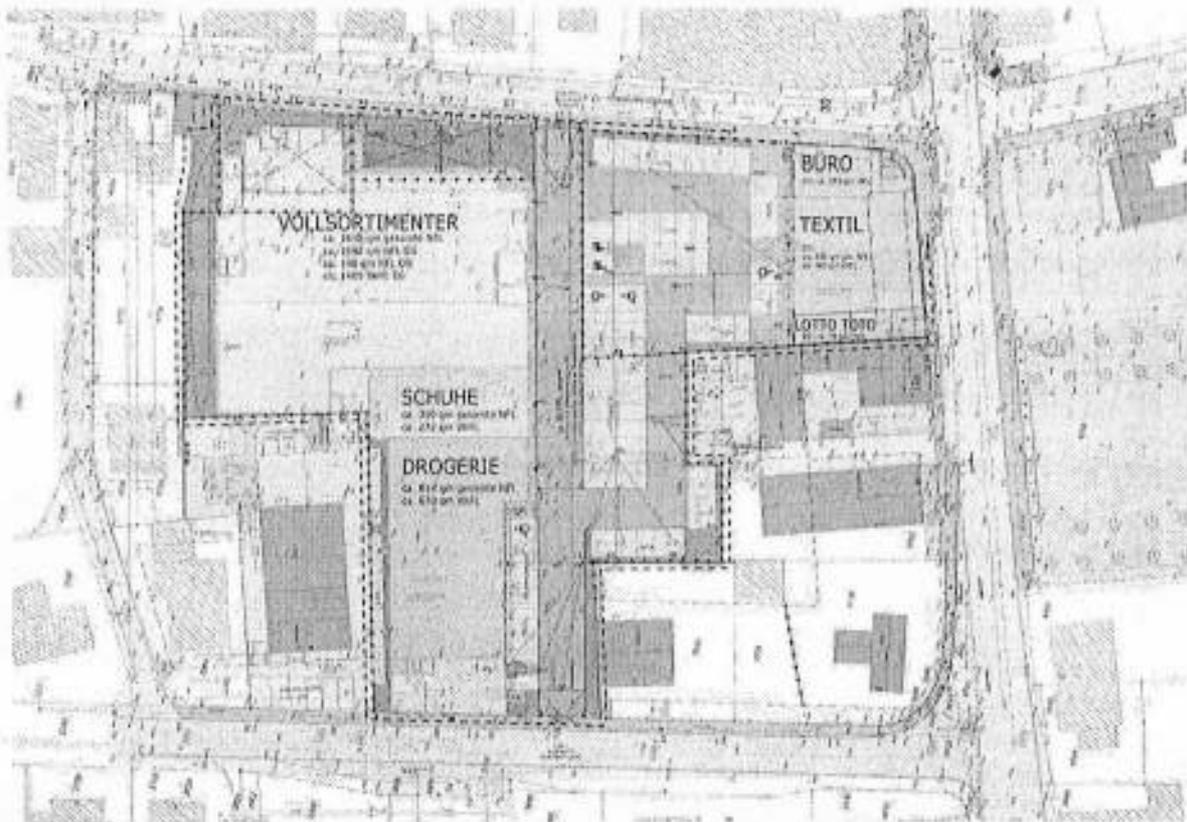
Lageplan (Quelle: Lageplan Variante 34, Ten Brinke, Stand: 26.11.2013)
